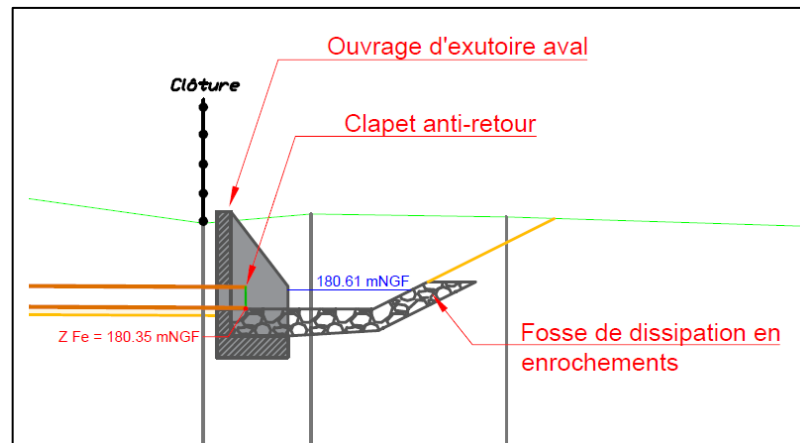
Coupe longitudinale de l'ouvrage d'exutoire aval
